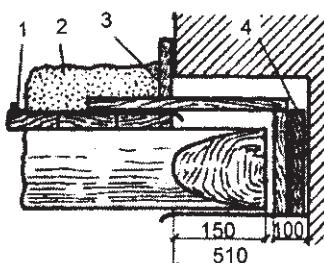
Заделка концов деревянных балок в чердачном перекрытии в стену толщиной в 2 кирпича
